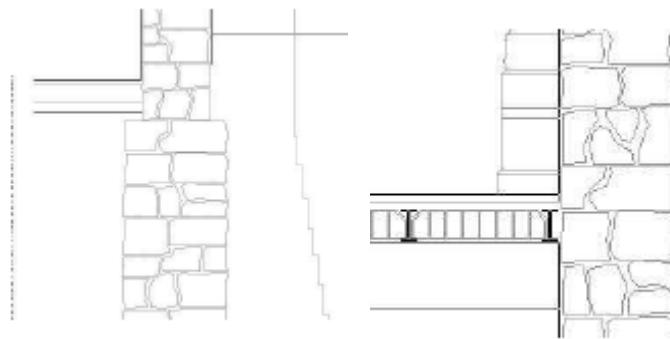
Cimentación. Foundations. Fig. 14. Muro de carga de piedra. Stone bearing wall.
